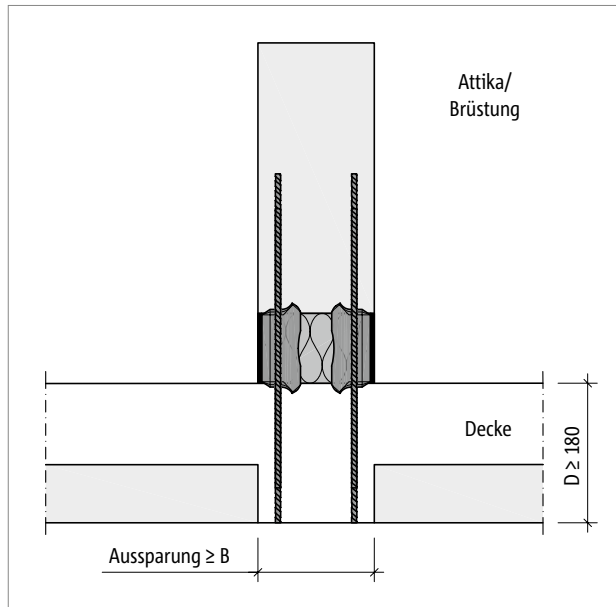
Schöck Isokorb® CXT Typ A: Schnitt; Mindestabmessung Aussparung Elementplatte
